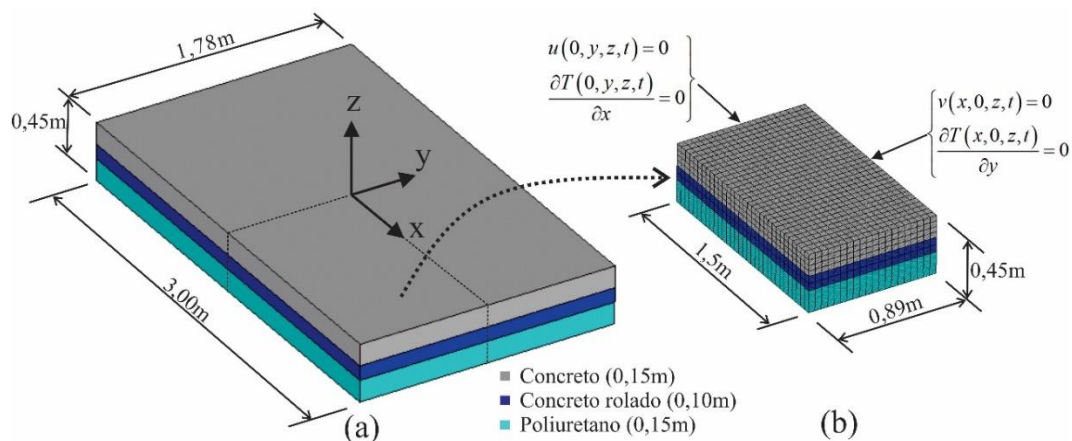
Geometria do pavimento de concreto (a) e modelagem de ¼ do pavimento via MEF com aplicação das condições de simetria (b).
